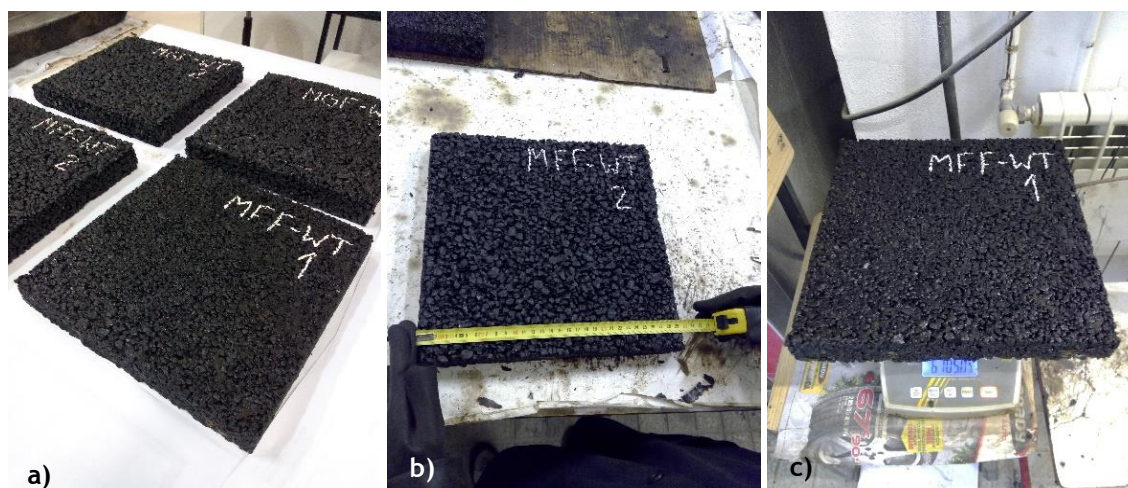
a) Lajetas após desmoldagem; b) Medição das lajetas para cálculo da baridade; c) Pesagem das lajetas para cálculo da baridade.
